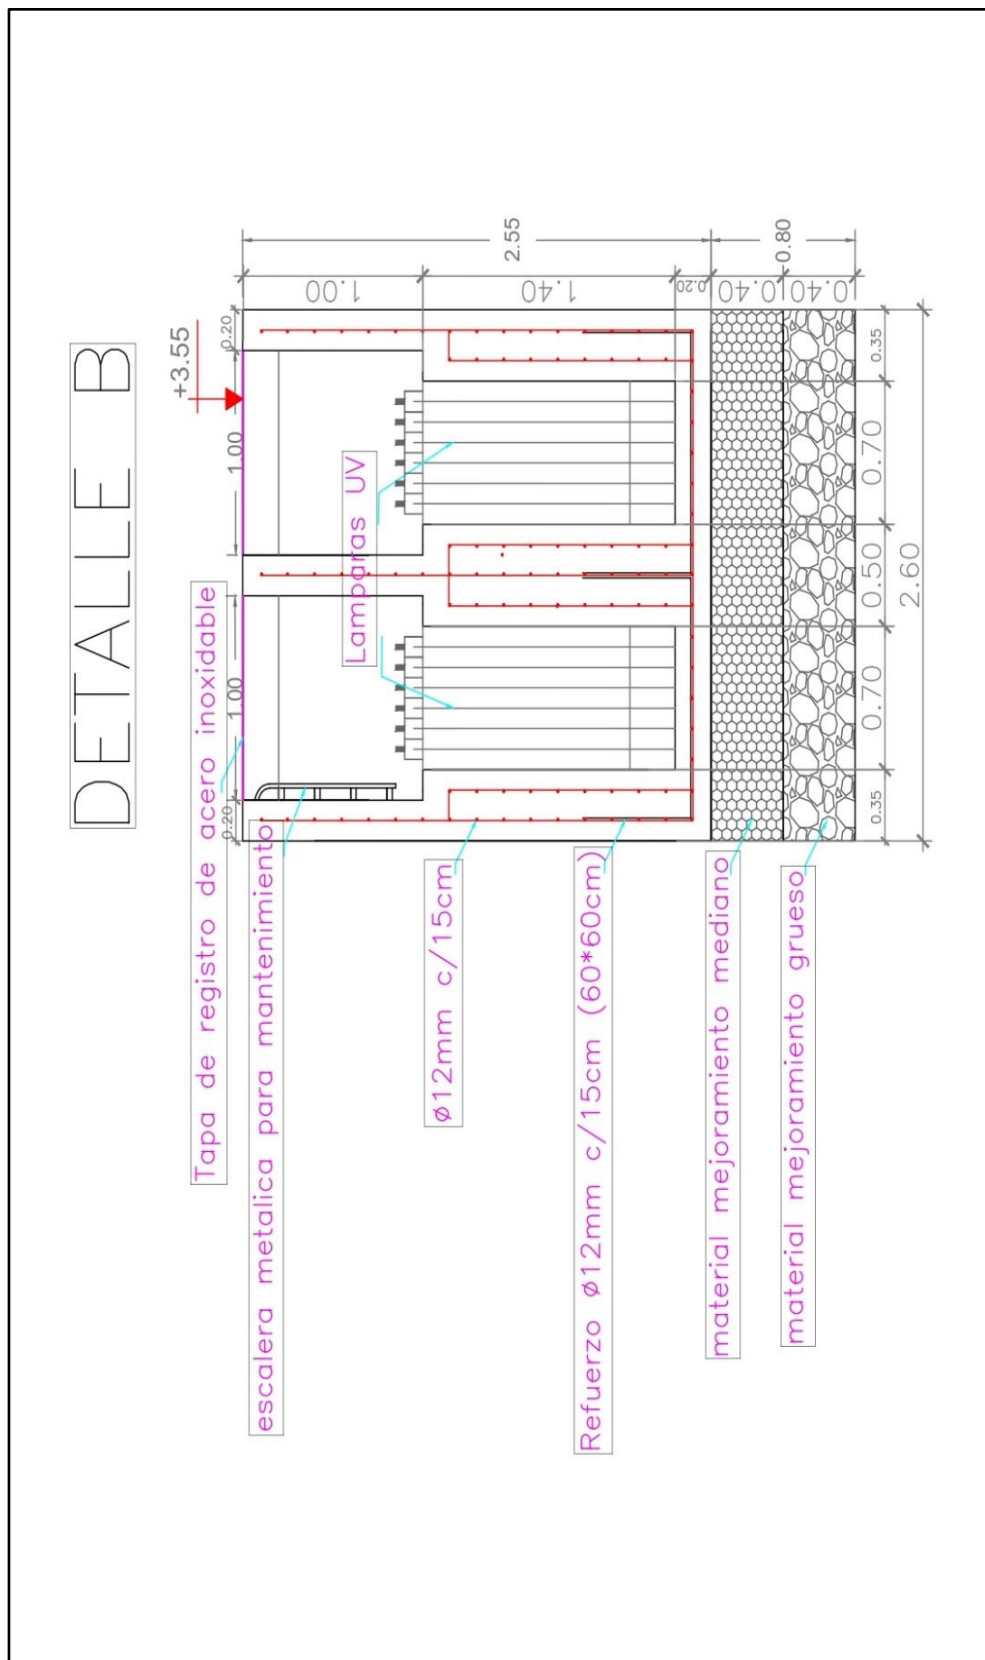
Detalle B (corte transversal) cisterna para equipo de desinfección
